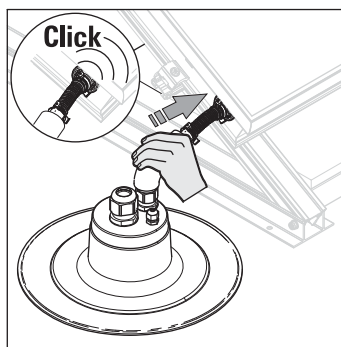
Kollektoranschlussbögen in Kollektoranschlussrohre stecken
